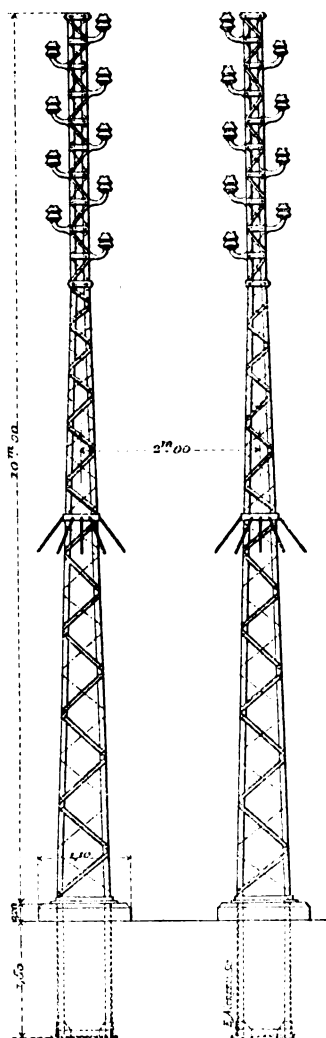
Poteaux métalliques isolés de la ligne de Paderno-Milan.
